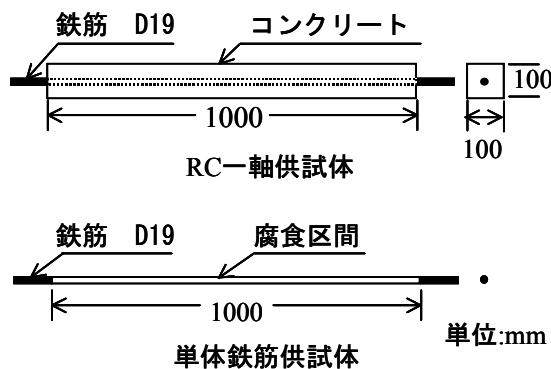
RC一軸供試体と単体鉄筋供試体の形状・寸法
